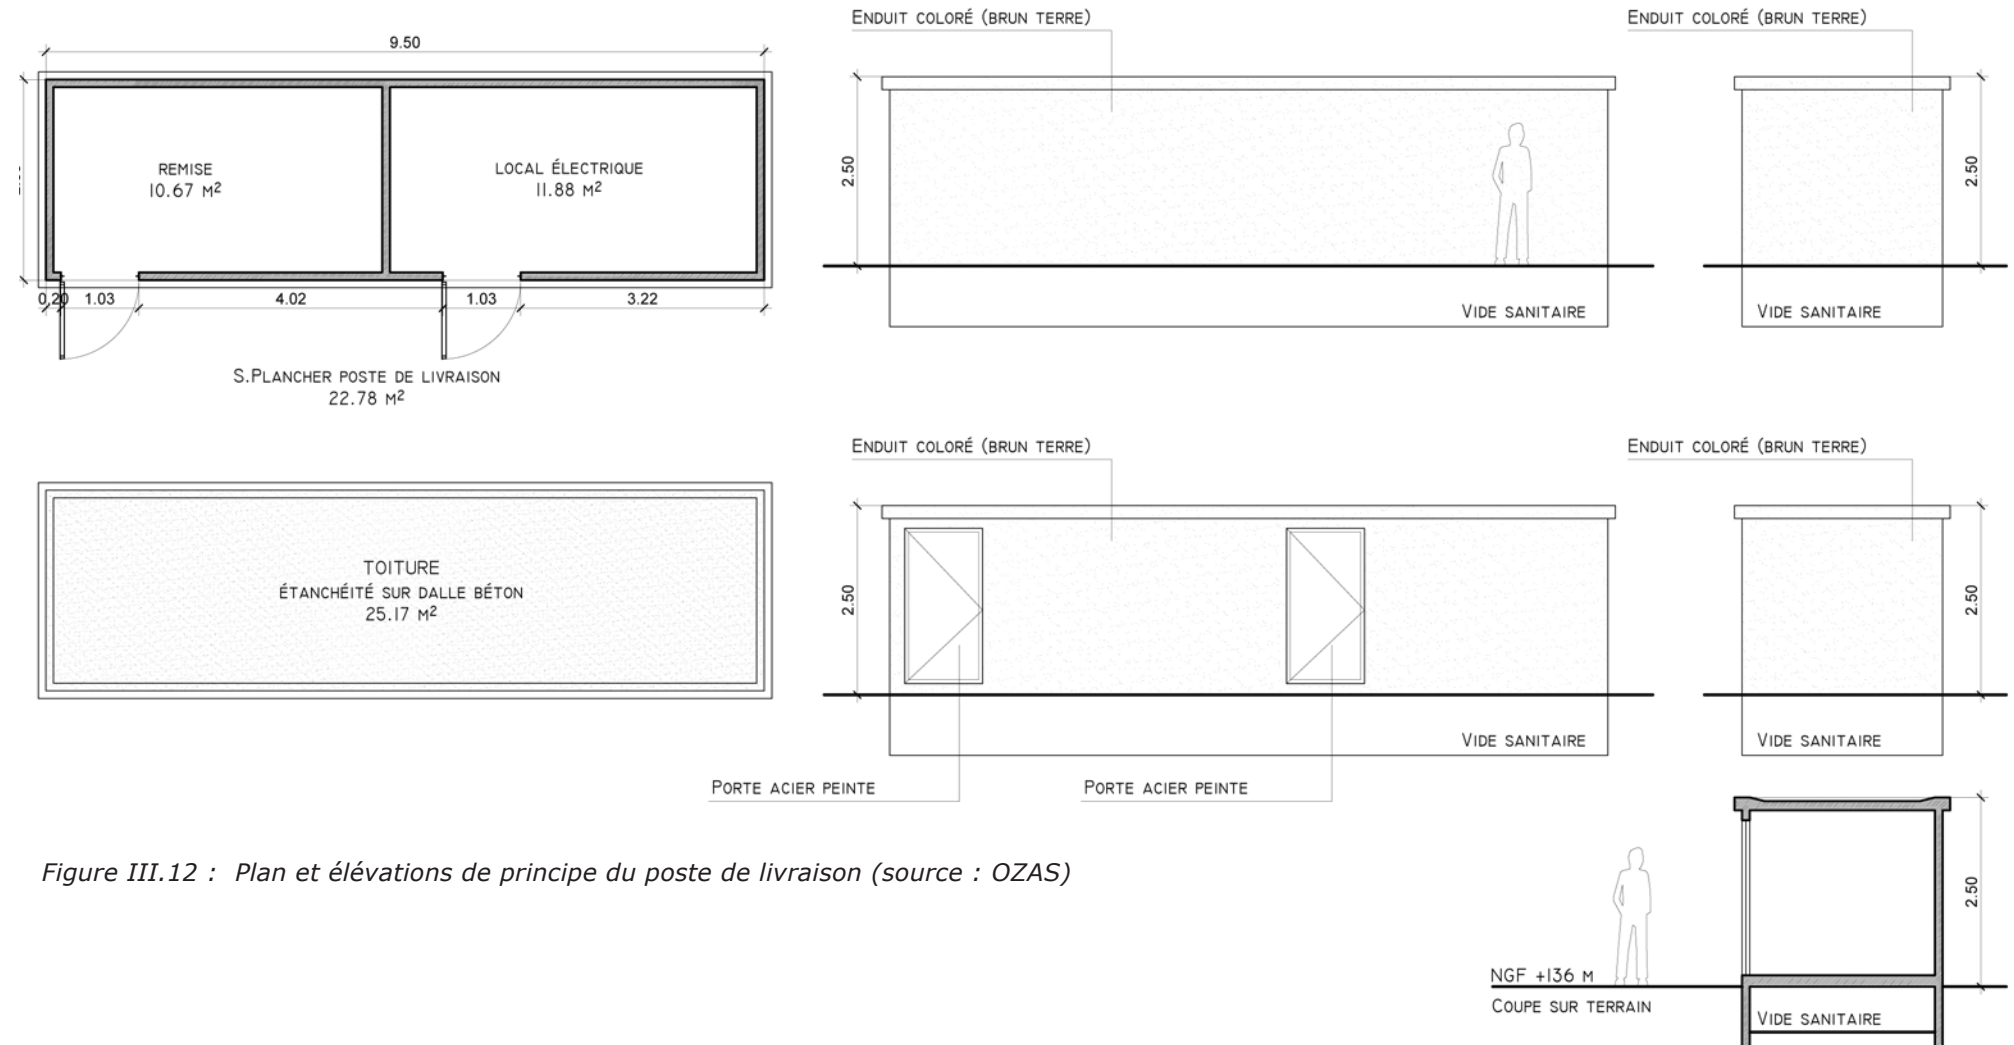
Plan et élévations de principe du poste de livraison (source : OZAS)
